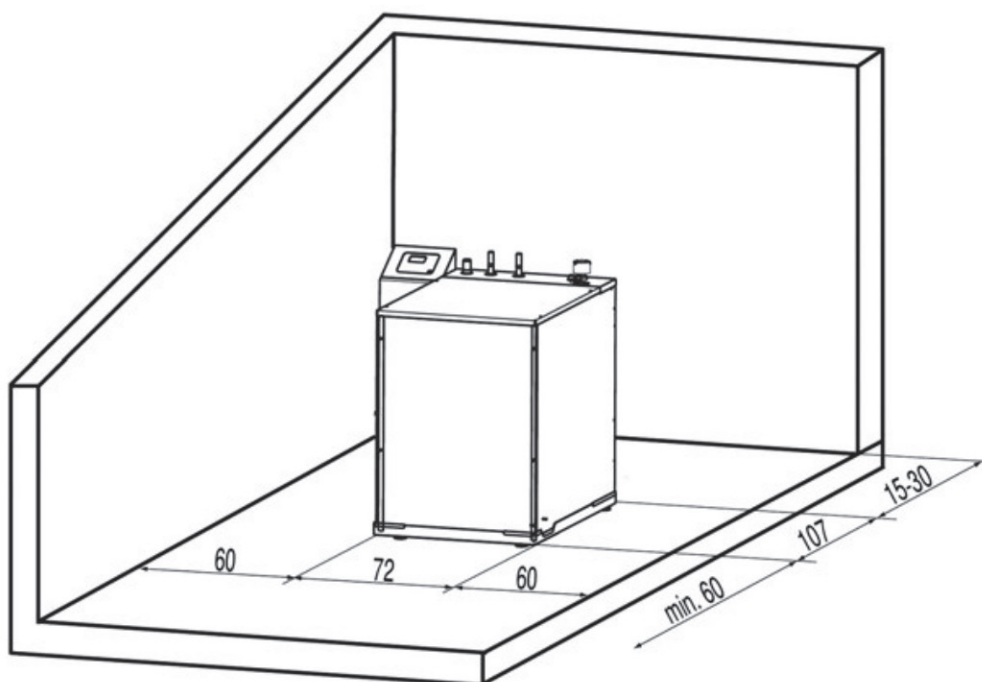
Installation d'une unité Dachs (source : Baxi Senertec).
